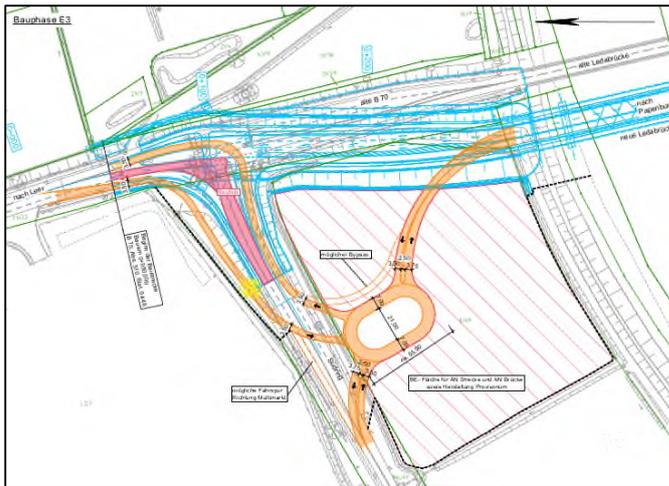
Lageplan Bauphasenplan Nord, Bauphase E3
